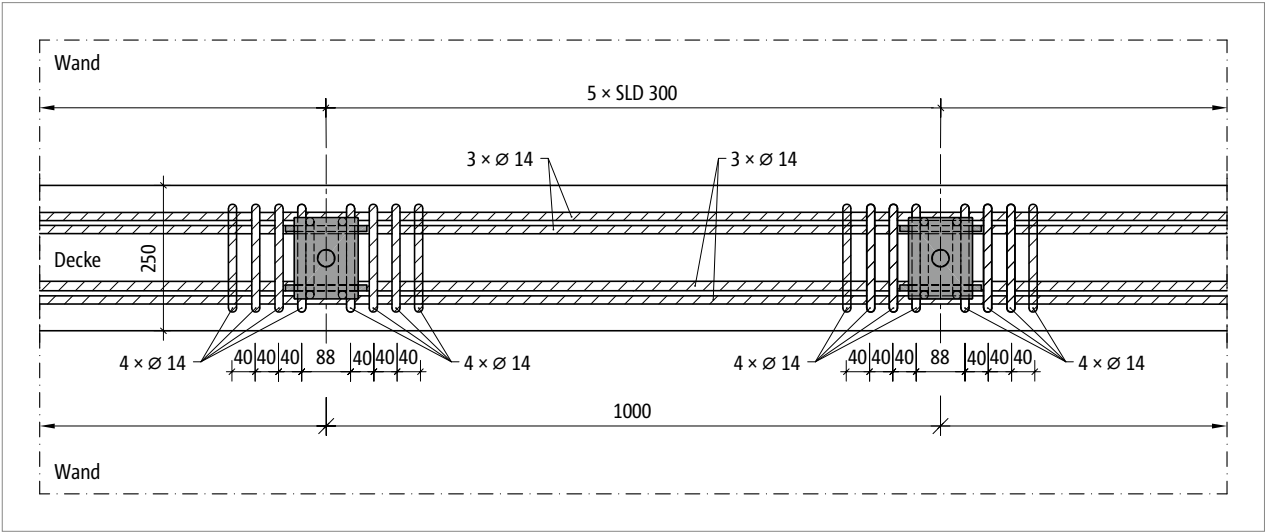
Ansicht der Decke mit Bewehrungsanordnung
